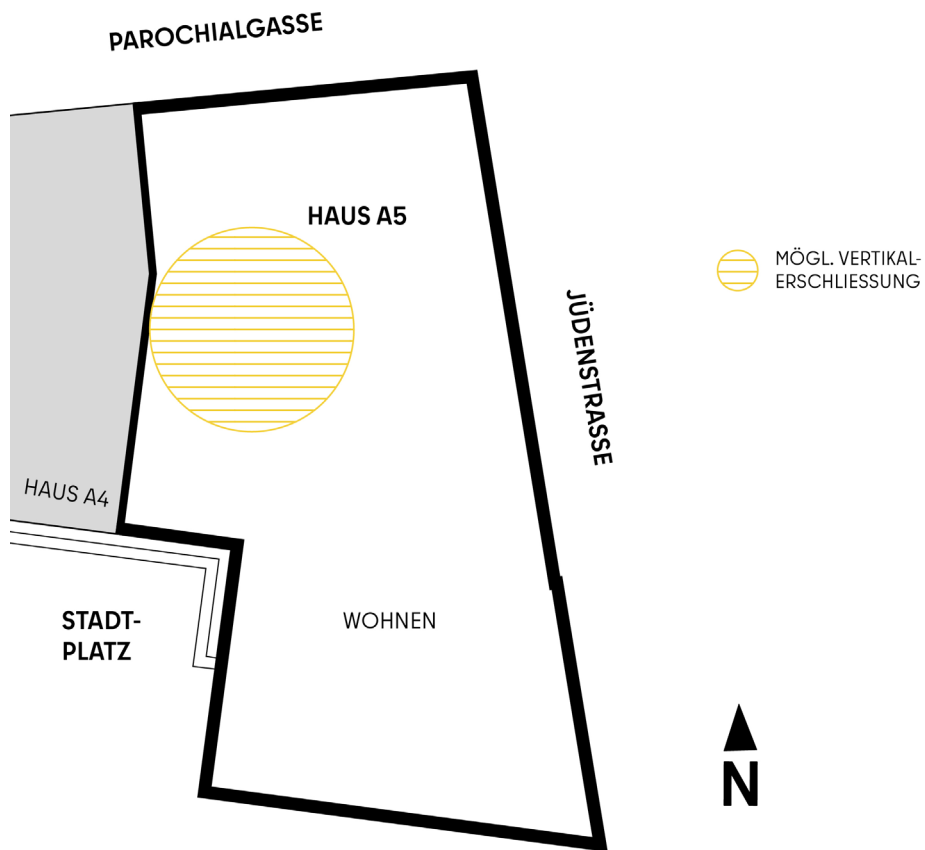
Schematischer Grundriss Regelgeschoss
